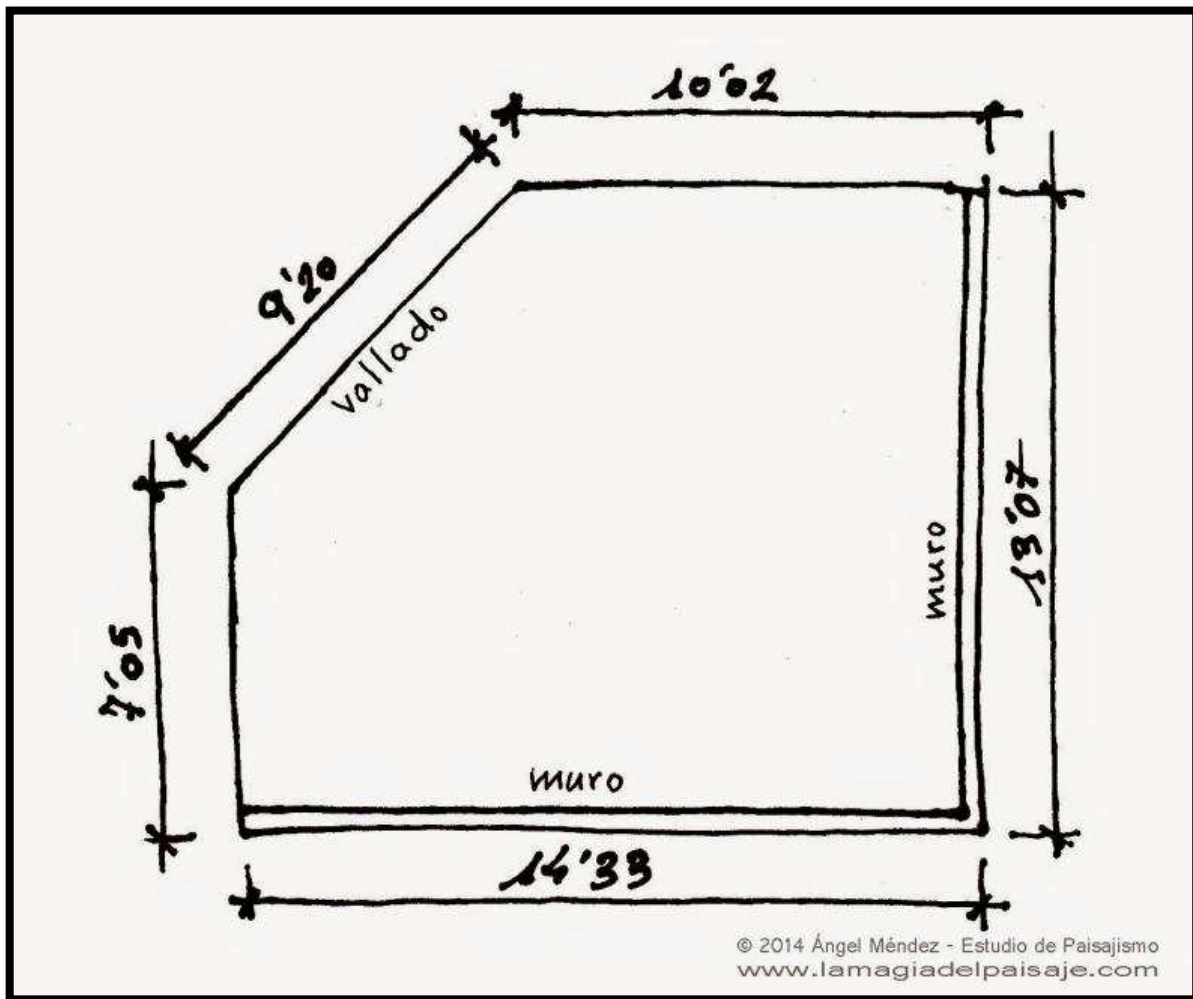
Croquis de un levantamiento a mano alzada. Fuente: Méndez, 2014.
